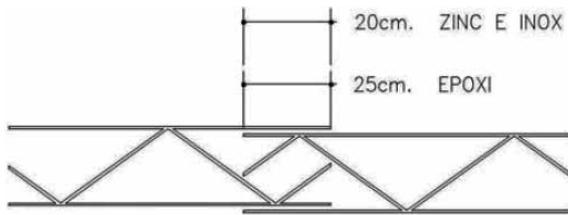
Longitudes de solape mínimas de las armaduras de tendel prefabricadas.
